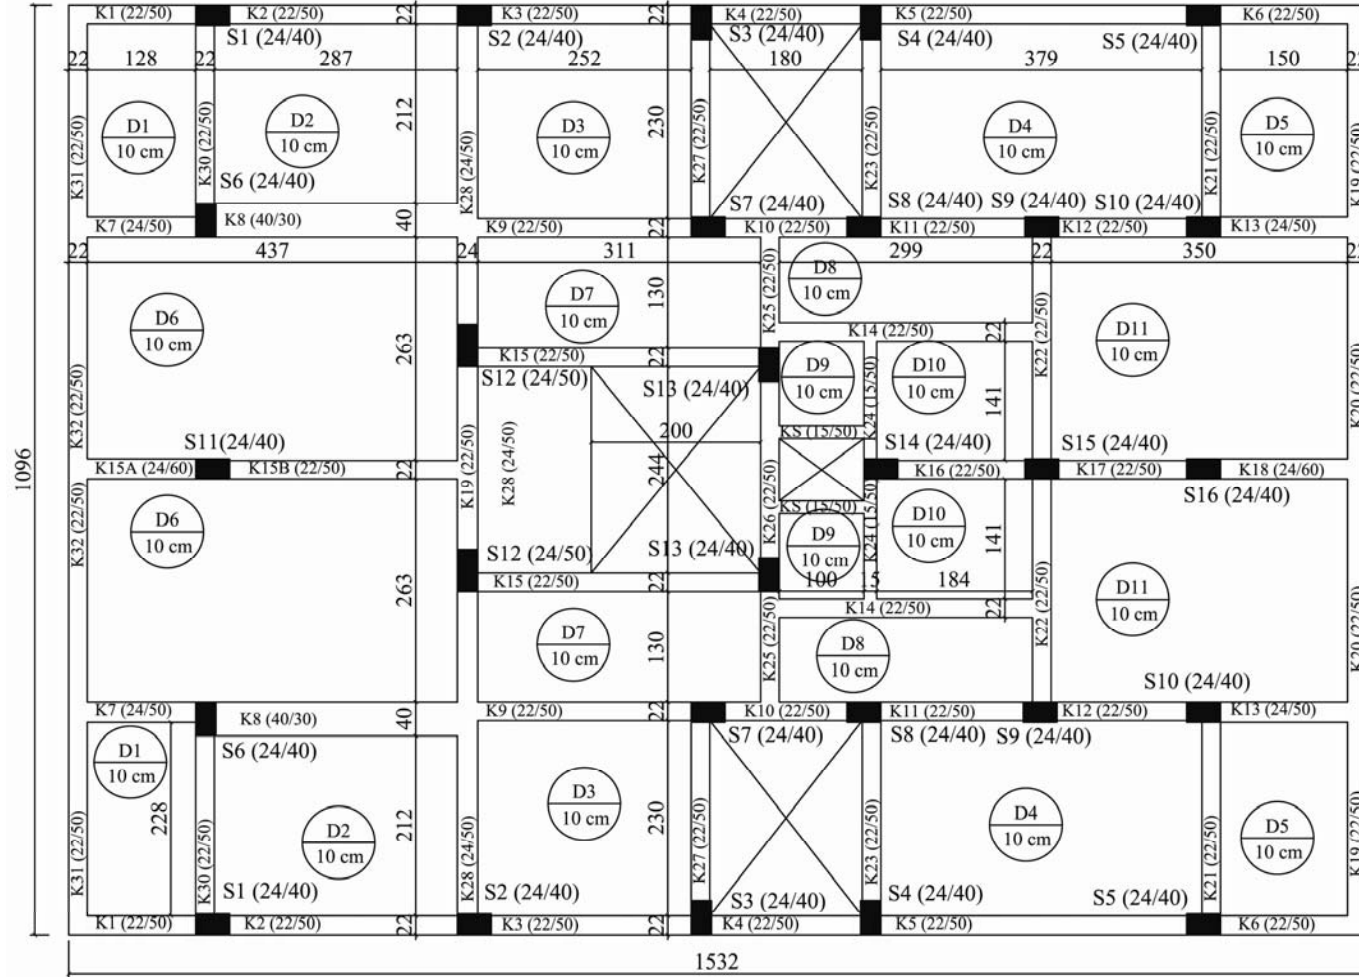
B3\_3'ün kat kalıp planı
